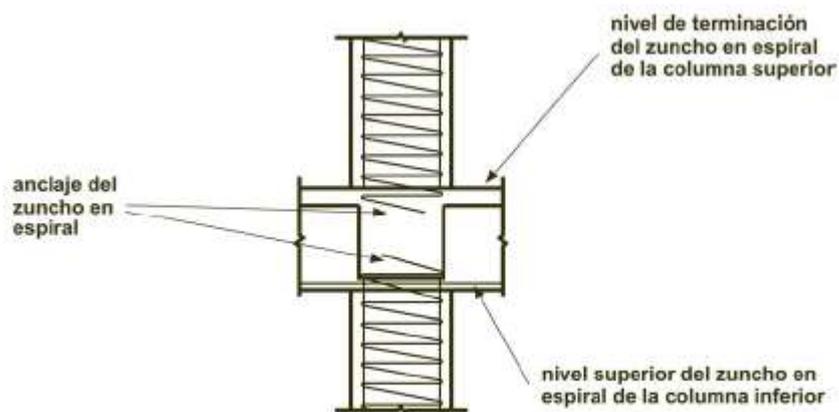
Anclaje de los zunchos en espiral para el caso de vigas en todas las caras de la columna.
